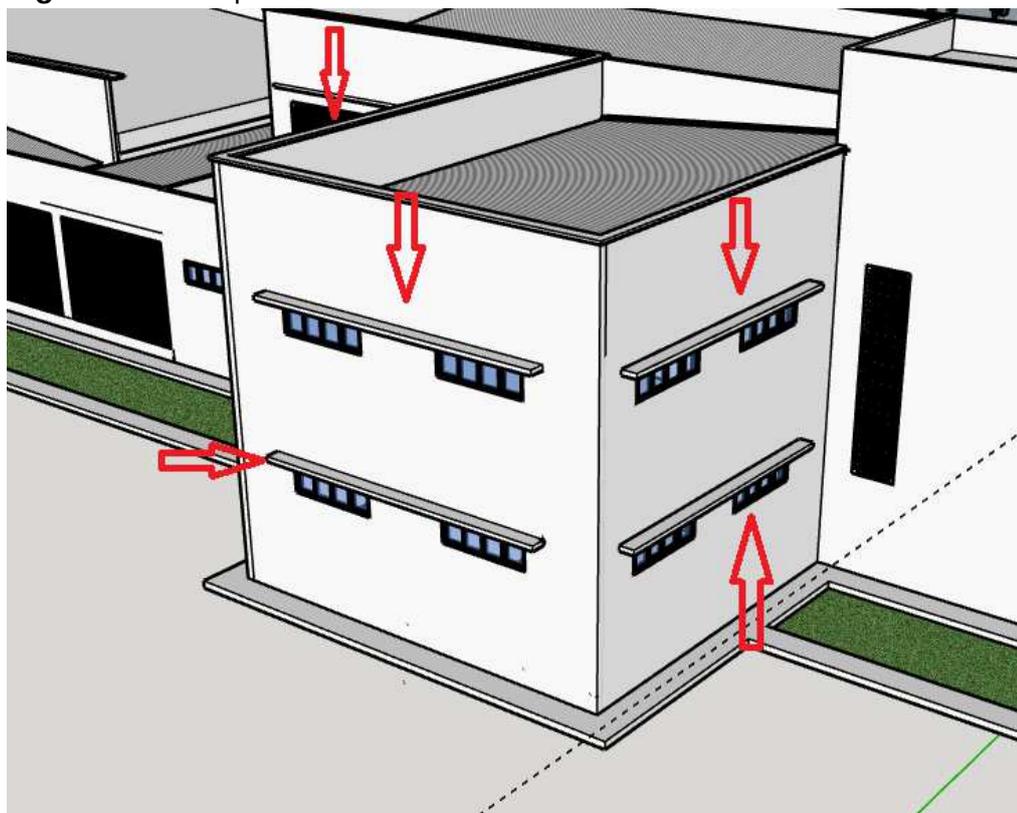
Vista 3D peitoril da escada no Segundo Pavimento
